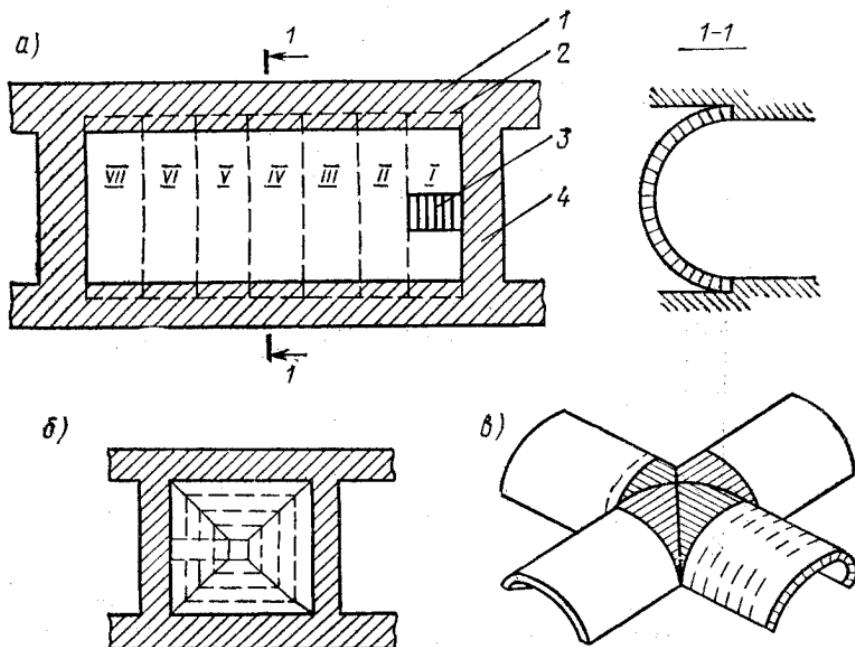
Схема разборки цилиндрического (а), сомкнутого (б) и крестового (в) сводов:
